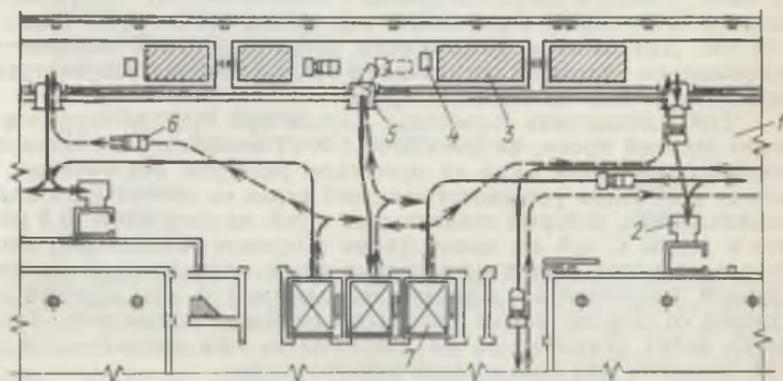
План железнодорожной рампы многоэтажного хранилища со схемой движения грузов:
